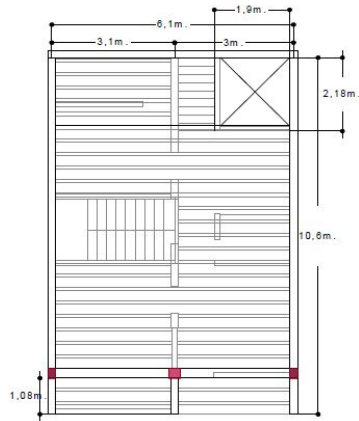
Planta estructural primer piso, Casa Buenos Aires
